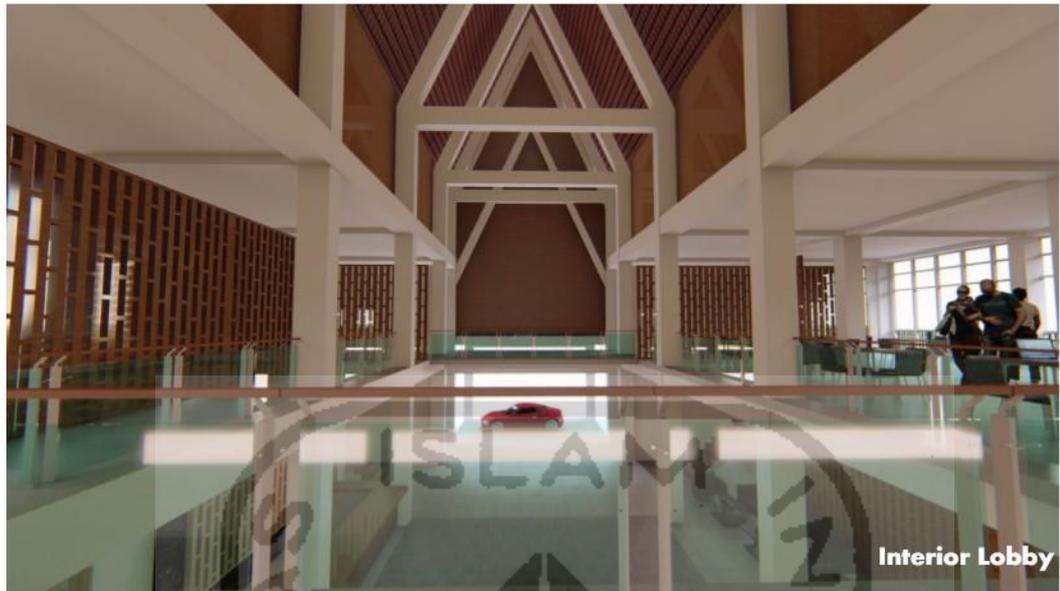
18 Detail Arsitektur Slembayung Hunian
